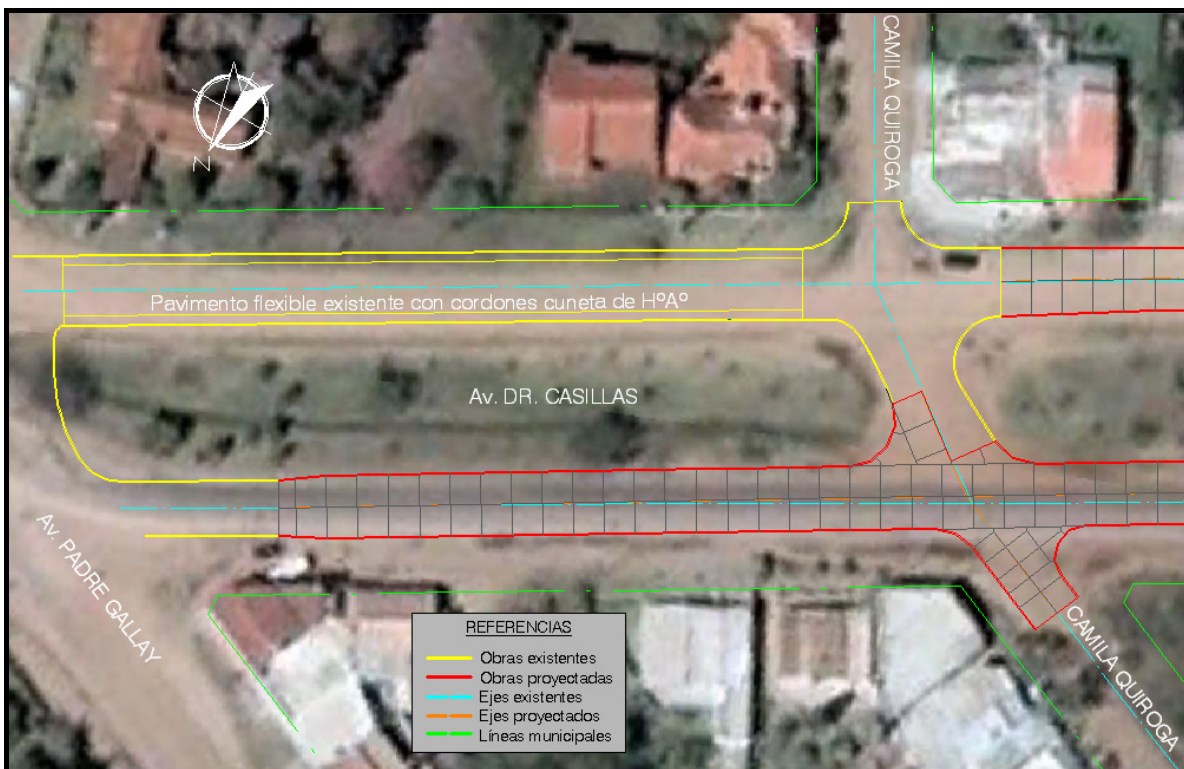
Detalle extremo Este de las obras proyectadas
